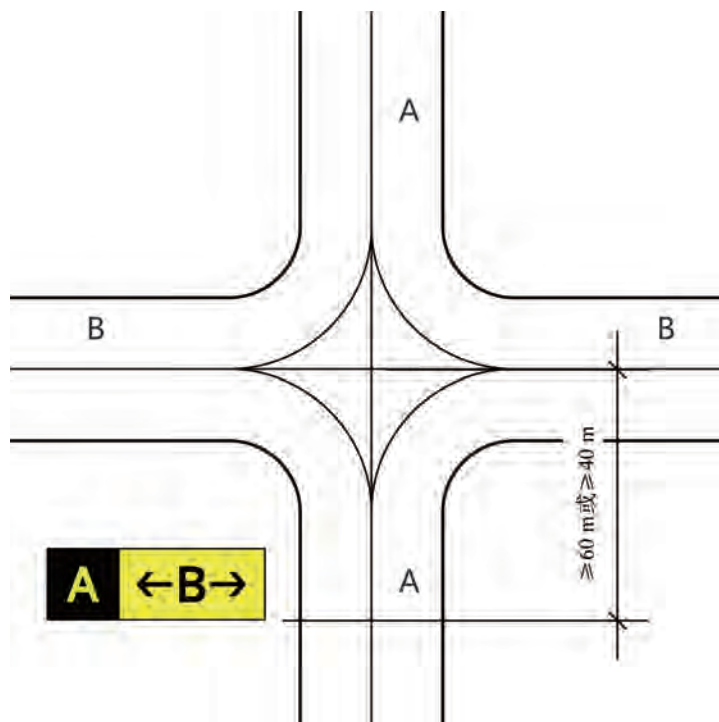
滑行道交叉处标记牌的布置示意图（二）
